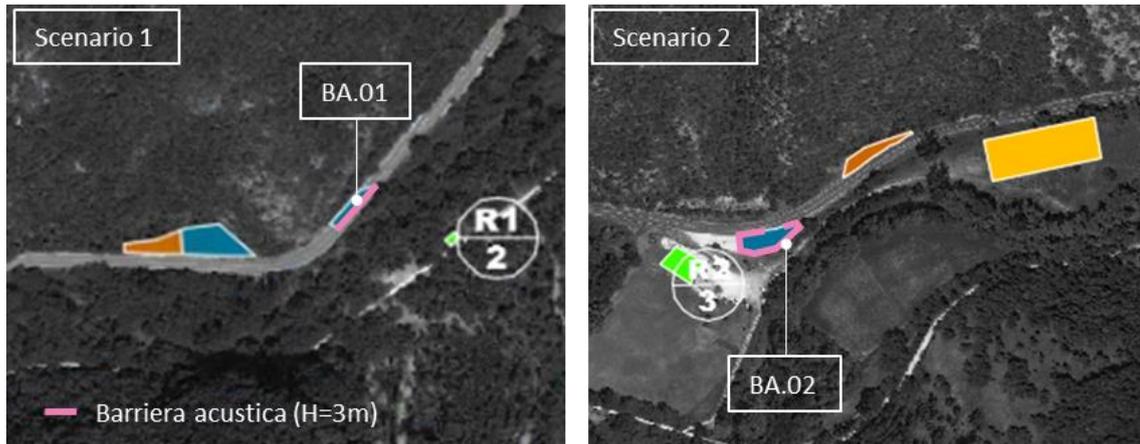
Localizzazione delle barriere acustiche di cantiere
